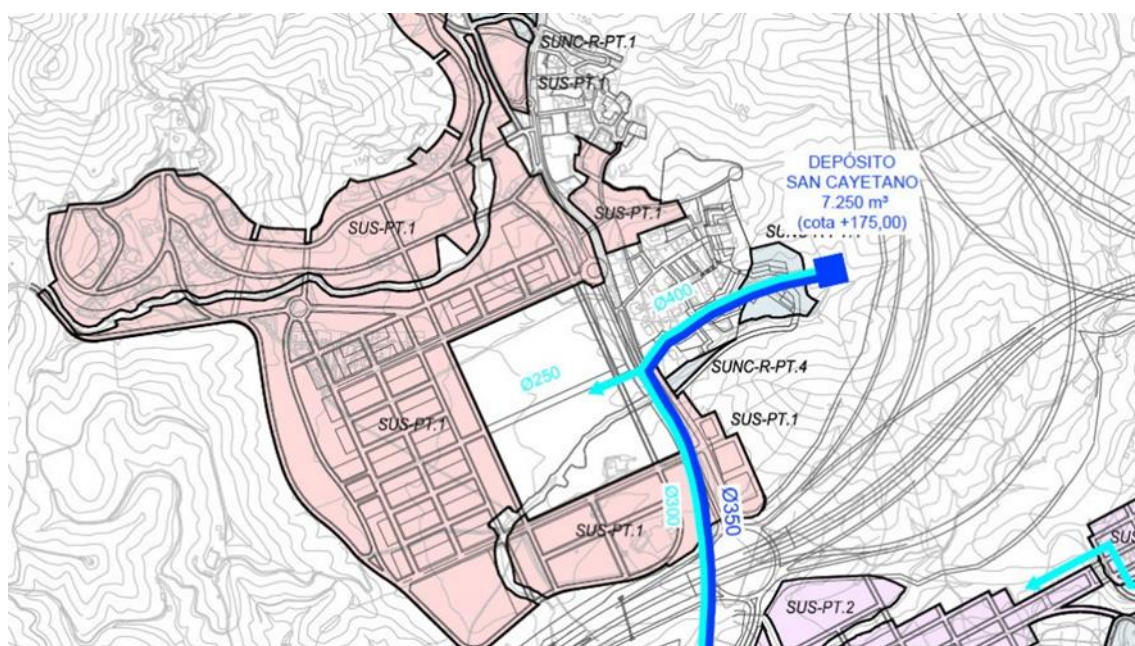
Previsiones del Plan de Infraestructuras Básicas de Málaga para los nuevos sectores del Puerto de la Torre.
